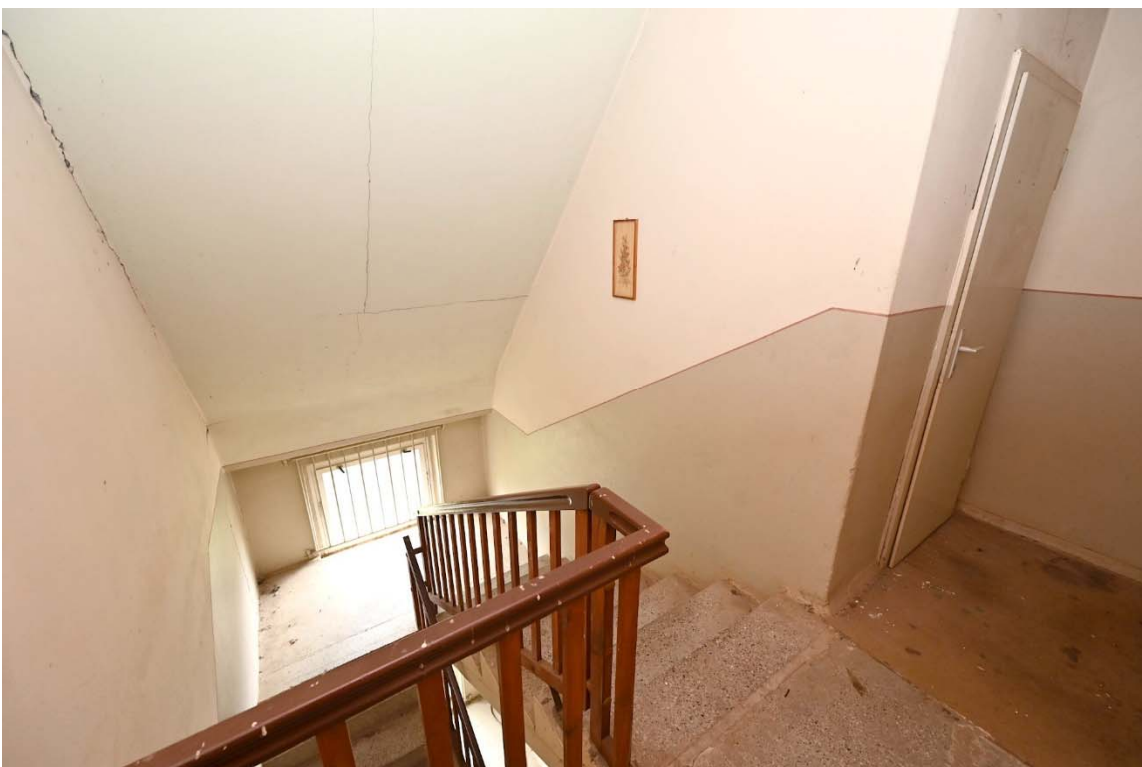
Treppenhaus Hauseingang 6b, Dachgeschoss (rechts Tür zum Trockenboden bzw. lt. ATP SE Nr. ⑮)
